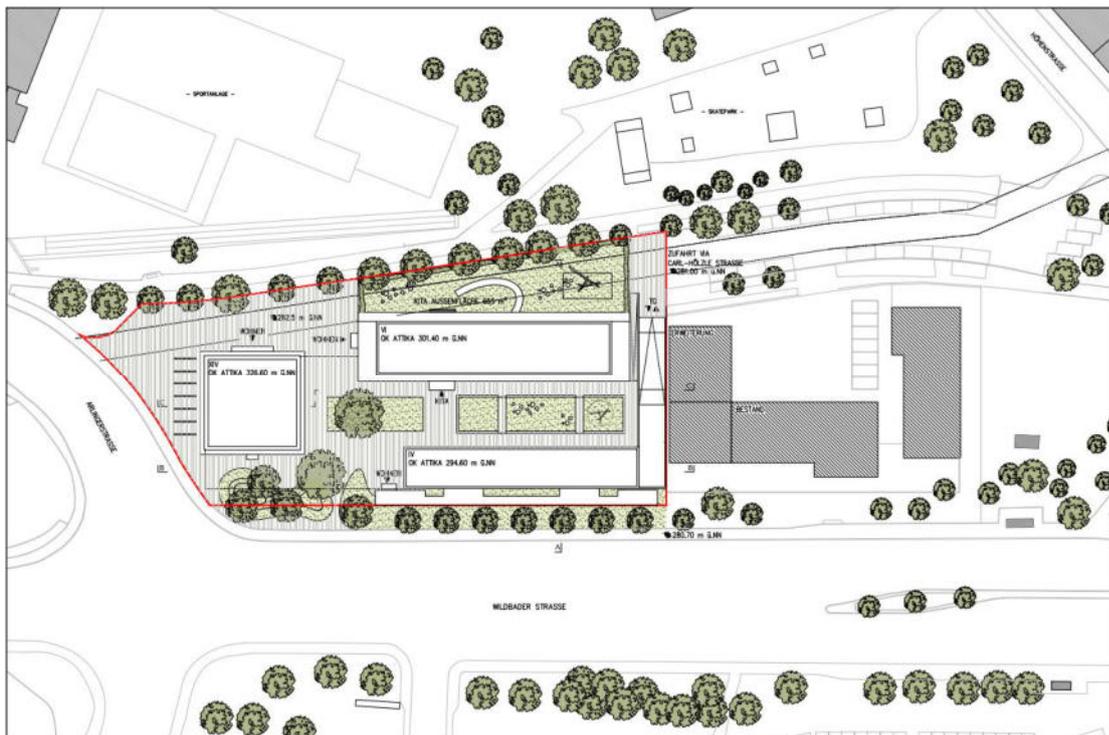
Lageplan Plangebiet (Quelle: PWS).
